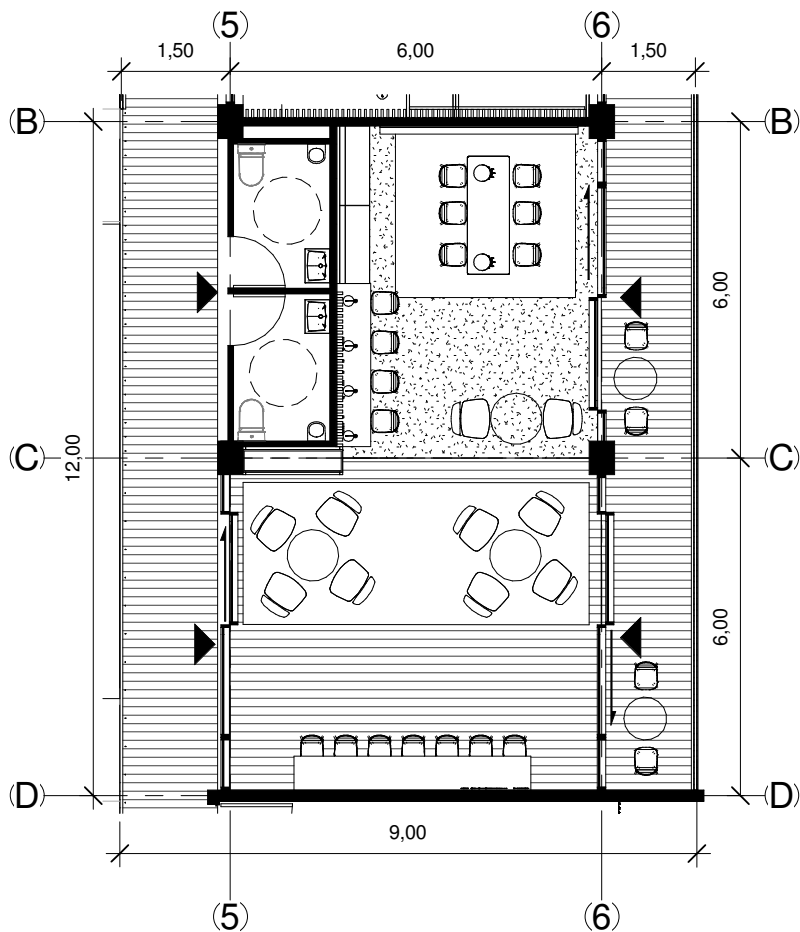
Ampliación planta área de trabajo colaborativo. Fuente propia.
